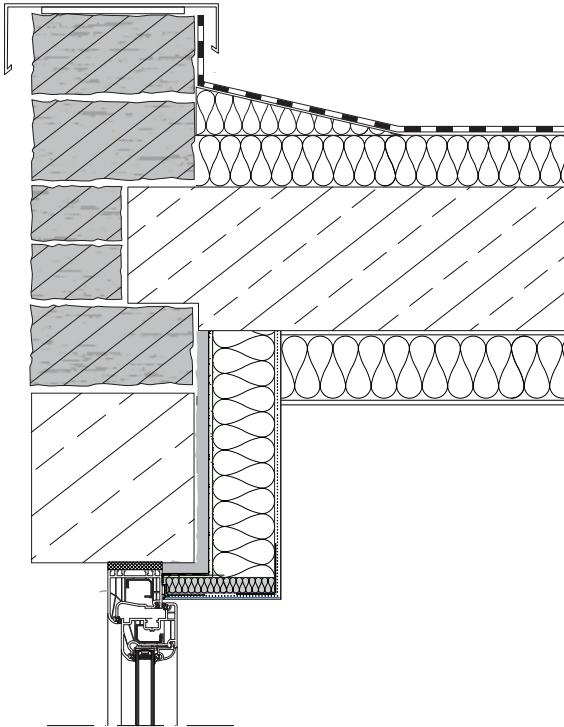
Flachdach; Vorhandener Mindestwärmeschutz mit Innendämm-System aufgewertet
